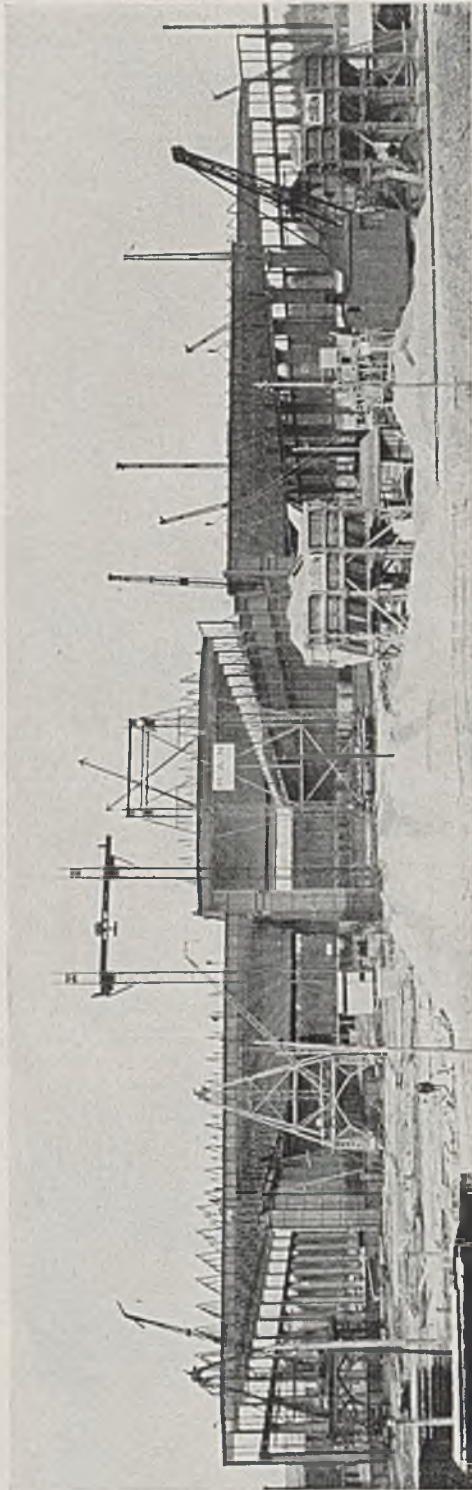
Bau 10: „Preßwerk“, Blick auf die Baustelle mit Montagegeräten gegen Ende der Montage.
